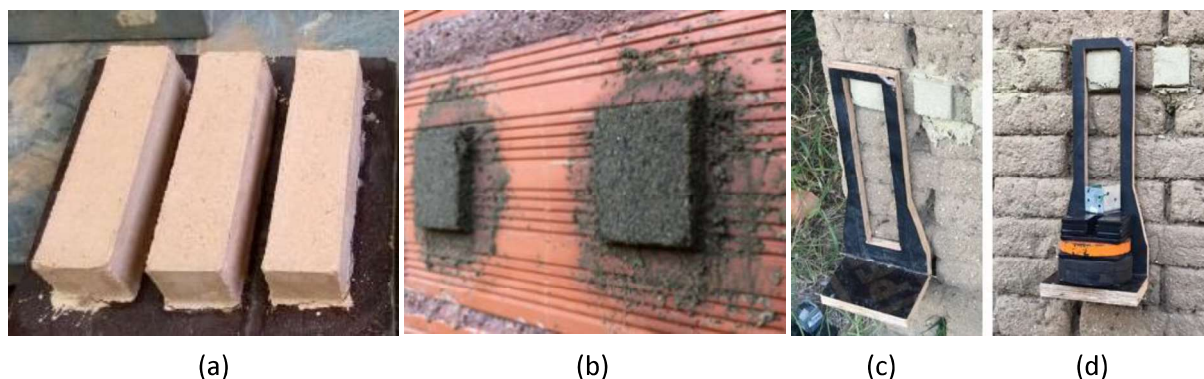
Corpos de prova prismáticos (a), corpos de prova de reboco aplicado em alvenaria de tijolo cerâmico vazado (b) e em adobe (c), sendo testados com dispositivo artesanal com a adição de massas (d).
